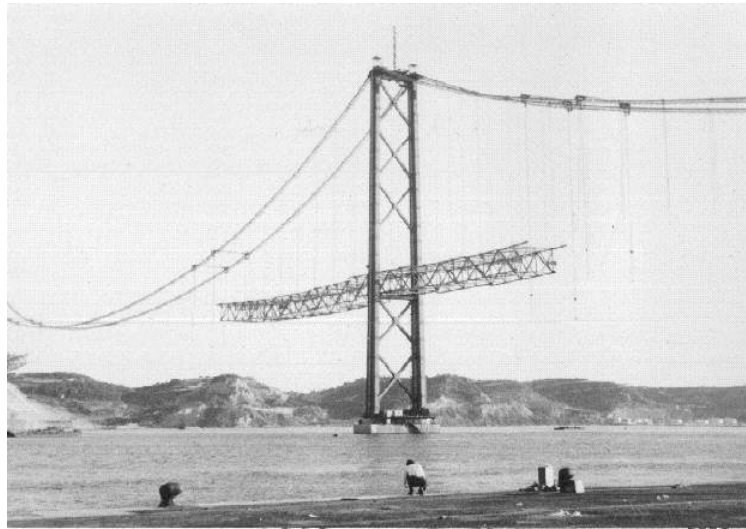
Construção da ponte 25 de Abril, Lisboa
